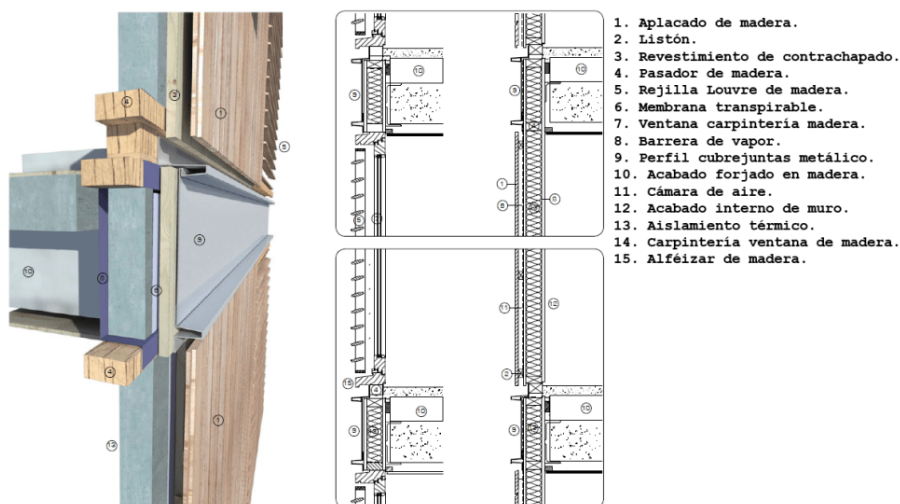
Sistema de fachadas ligeras (<http://cort.as/-LI3Z>)
